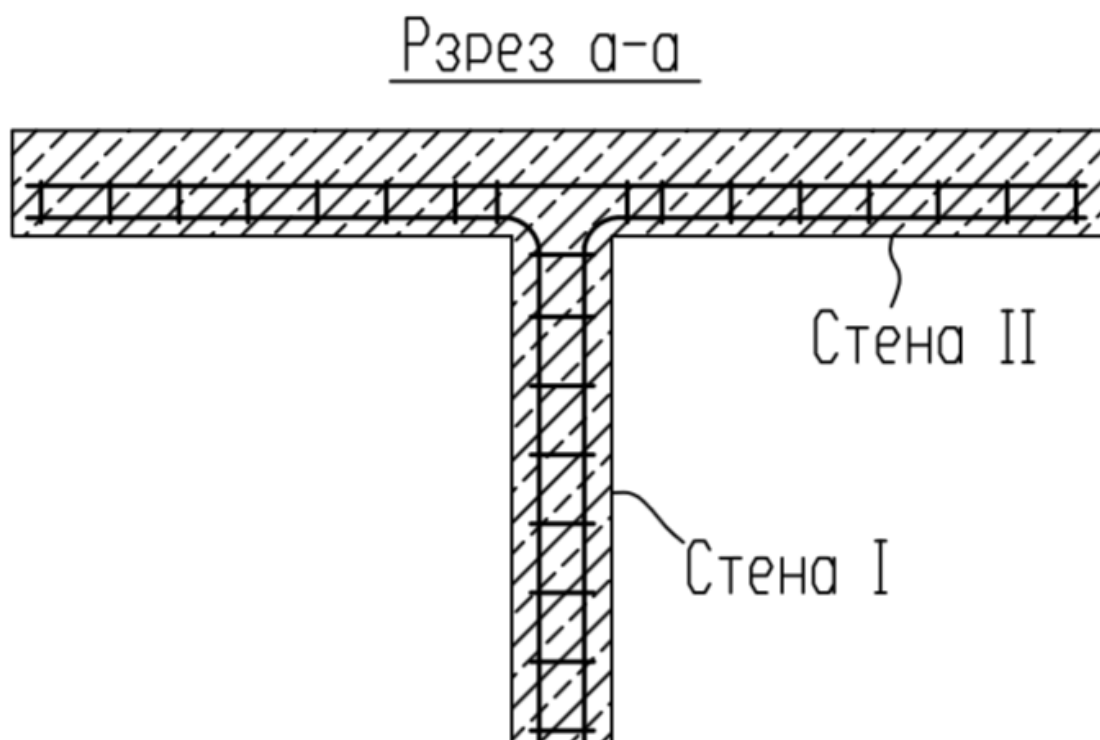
Разрез армирования внутренней и наружной стен. Расположение отгибов в зоне стыка разнодеформируемых стен
